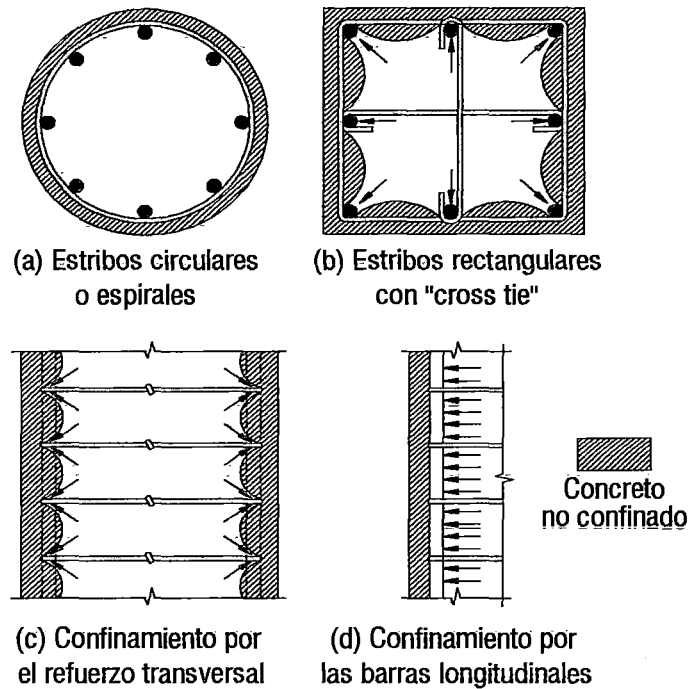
Confinamiento de secciones de columnas mediante refuerzo longitudinal y transversal[23]
